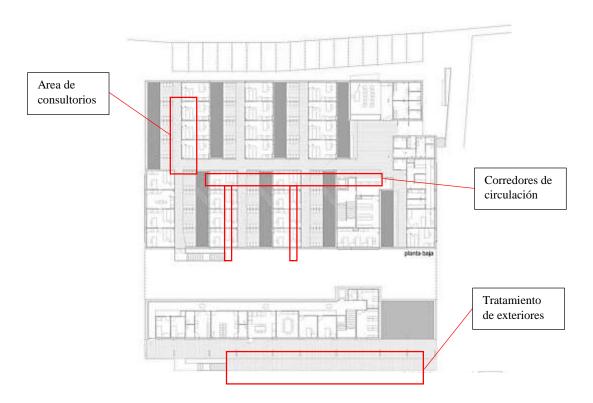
Planta baja centro de salud Adaptado de (Carles Muro-Charmaine Lay, 2010)
